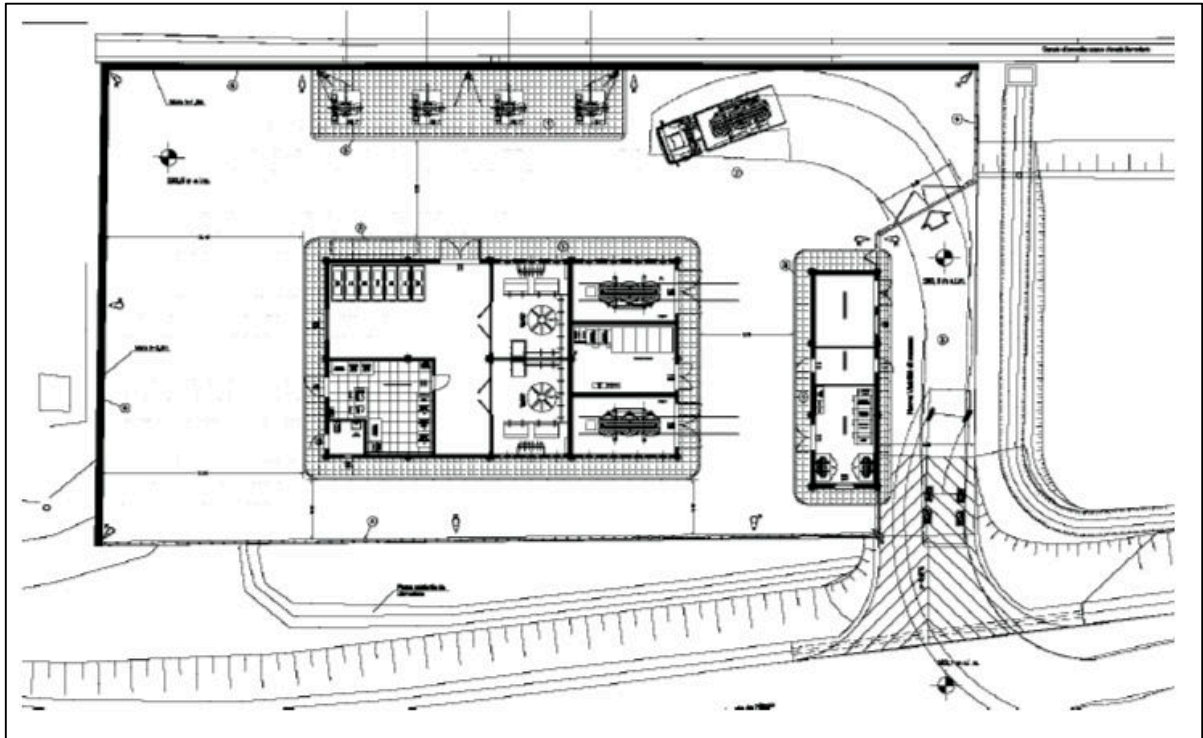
Progetto della nuova S.S.E. - Planimetria (Fonte: Fonte: All. 7 alla Lista di Controllo *Relazione Aspetti ambientali della cantierizzazione*)
